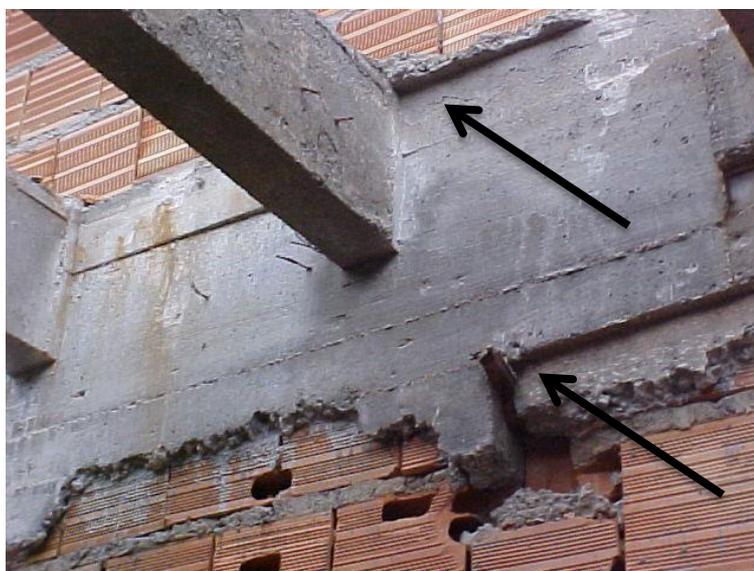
Vigas em concreto armado com irregularidades geométricas.
